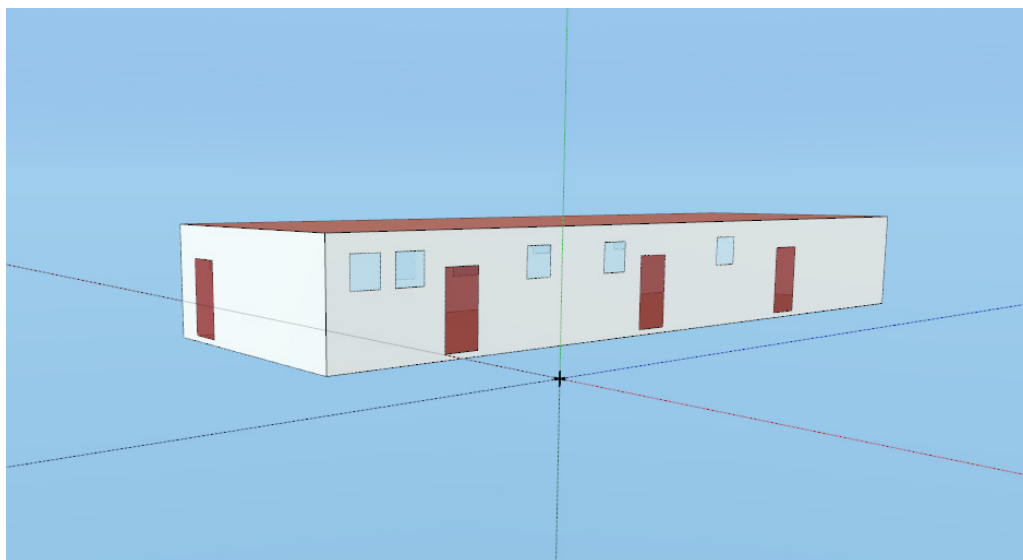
Widok elewacji frontowej budynku wielofunkcyjnego
